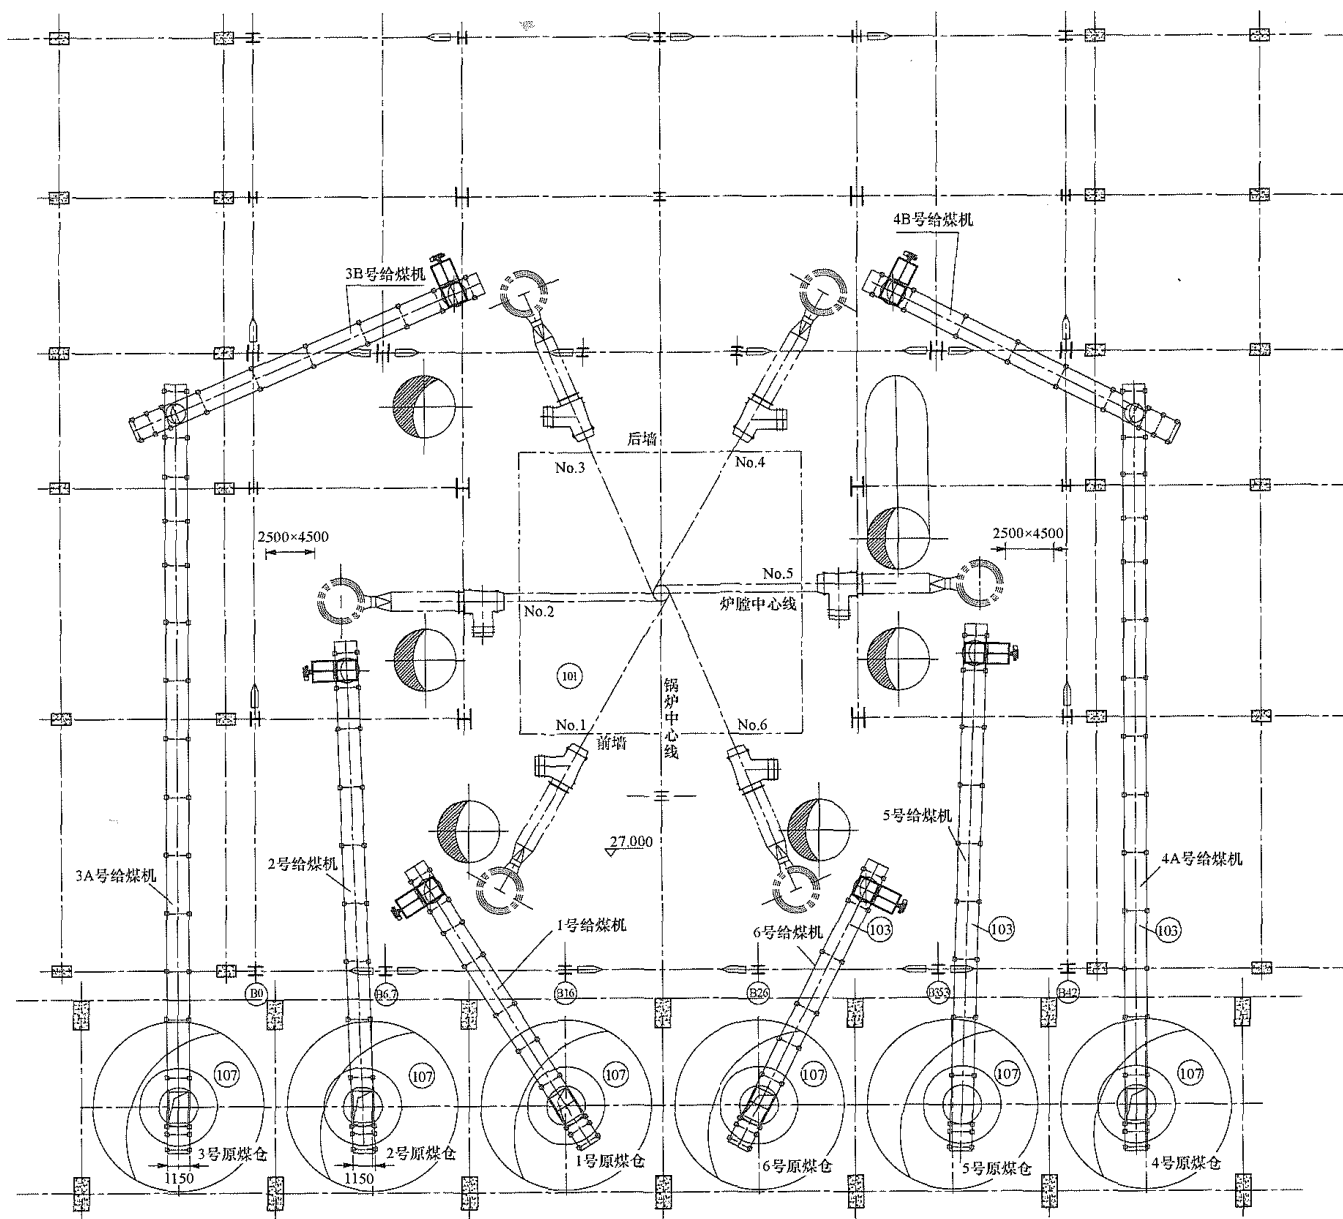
300MW 级机组风扇磨煤机前煤仓给煤机层平面布置图
